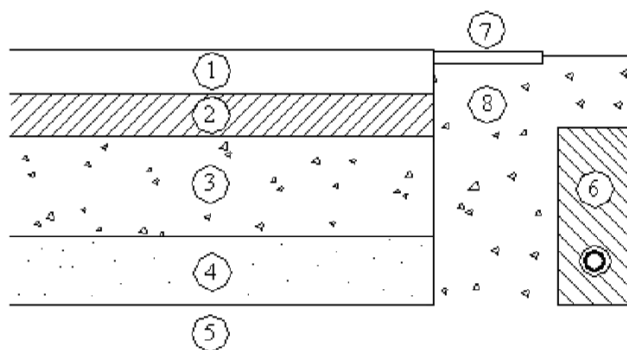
Sección típica de un pavimento. Fuente: Instituto Tecnológico de Aeronáutica, Ingeniería de Pavimentos, Brasil, 2000.
